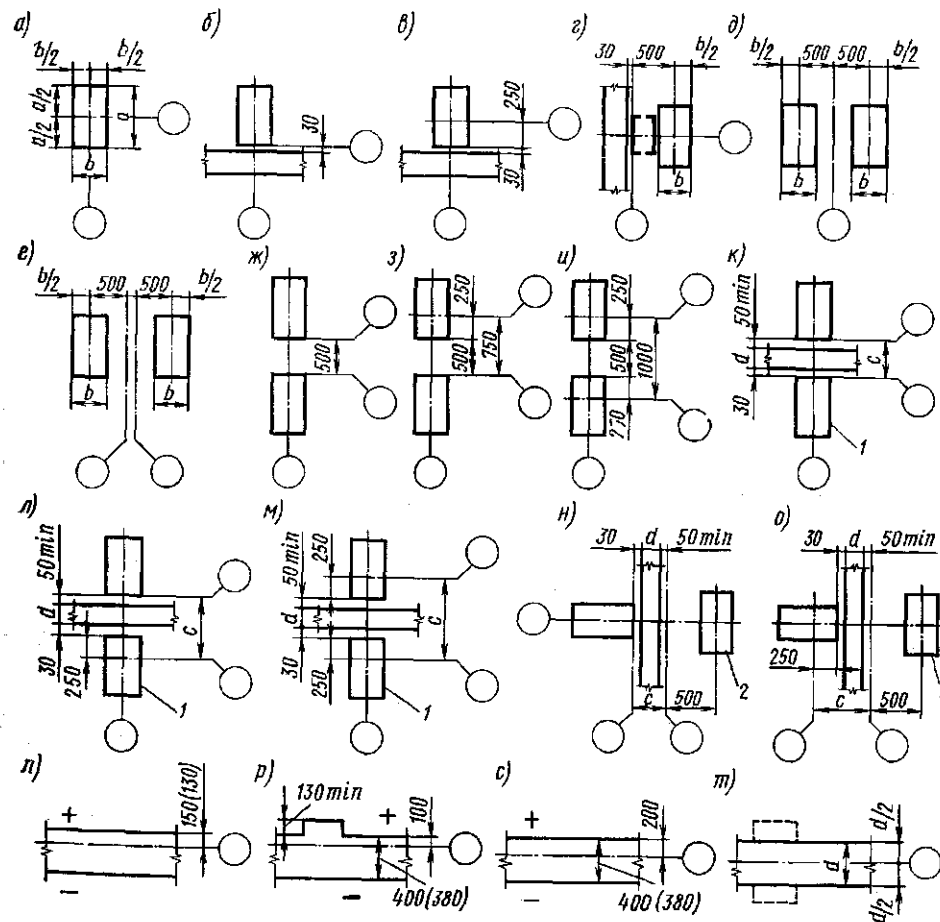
Привязка колонн и стен одноэтажных зданий к продольным и поперечным разбивочным осям:
